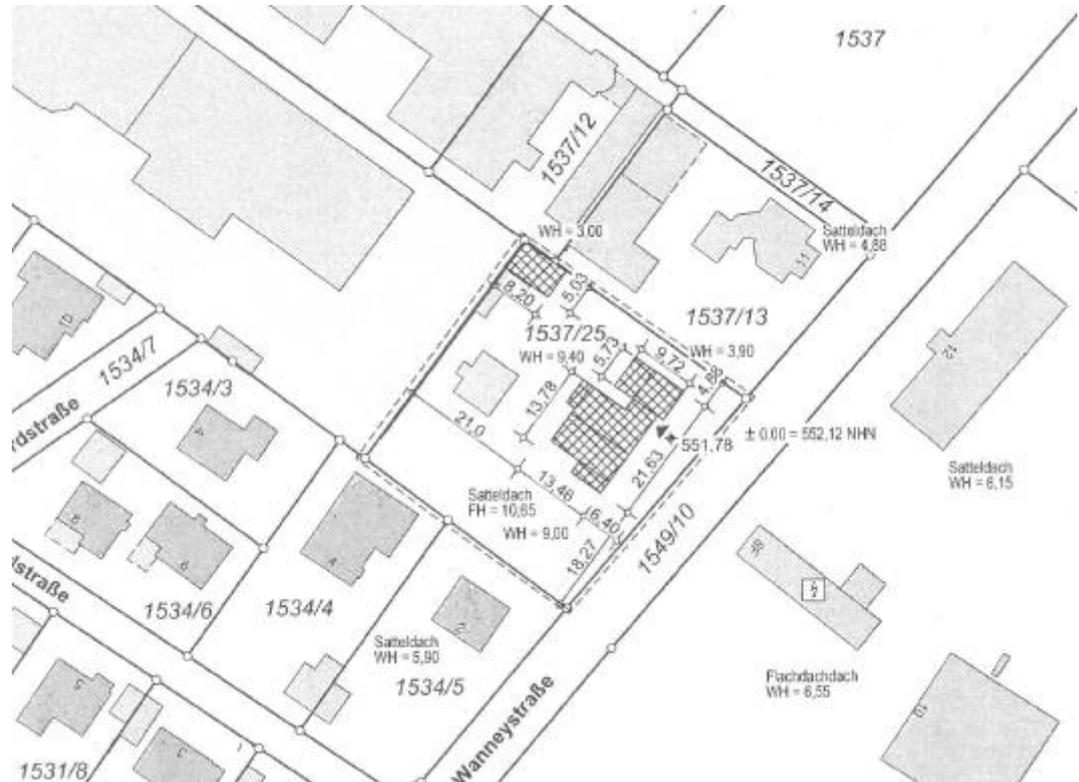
Lageplan, 20.02.2022, ohne Maßstab
